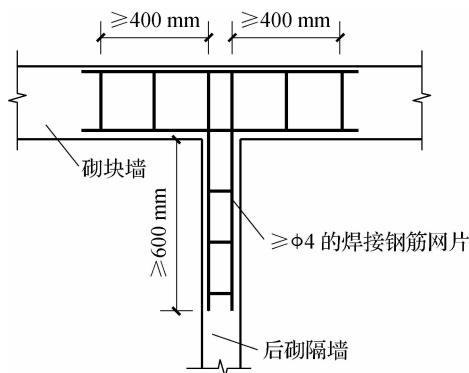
砌块墙与后砌隔墙交接处的钢筋网片示意图
